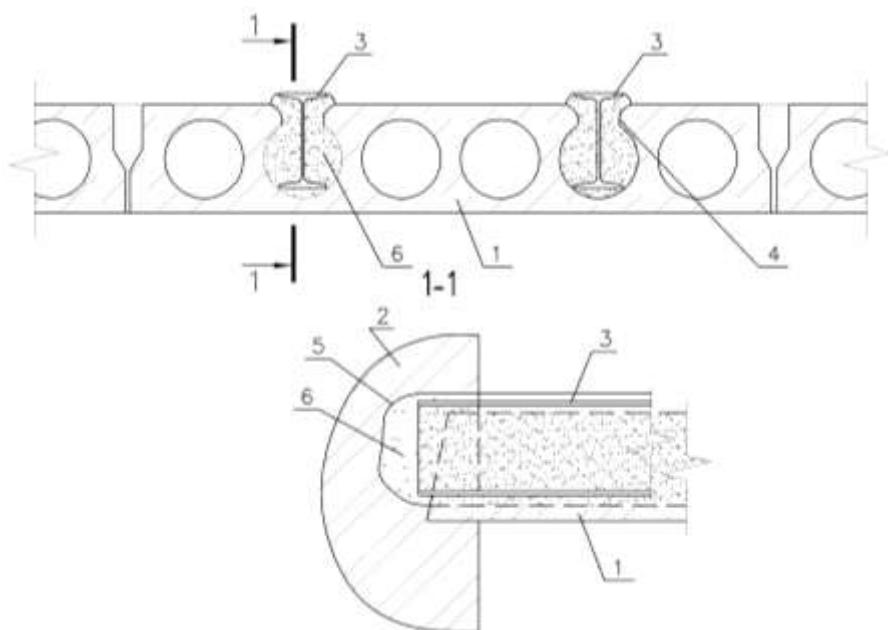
Установка металлических балок в пустоты сверху с последующим их обетонированием.
